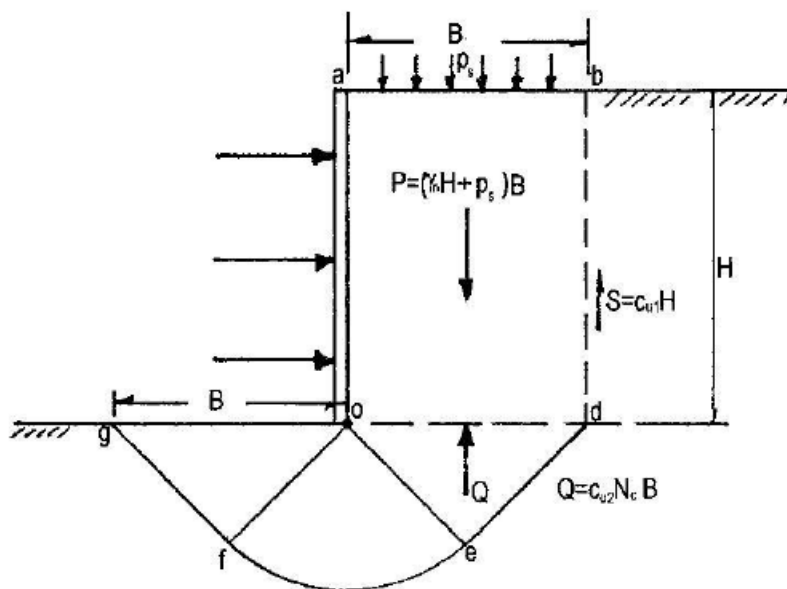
Mecanismo de Terzaghi-Prandtl para la falla de fondo de excavaciones ademas en arcilla saturada con longitud, ancho y profundidad infinitos (Recuperado: Ingeniería de cimentaciones).
